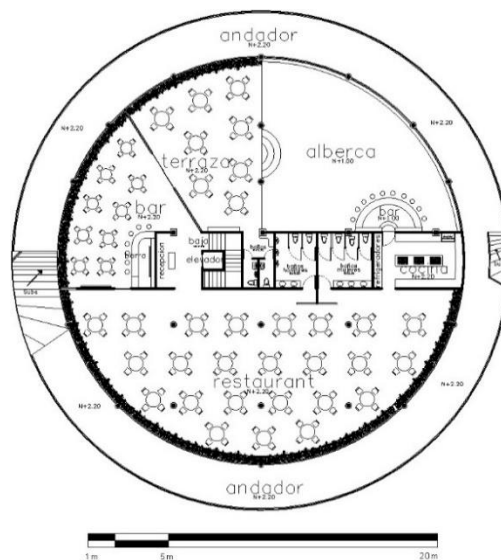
Planta arquitectónica del restaurante-mirador nivel 2
